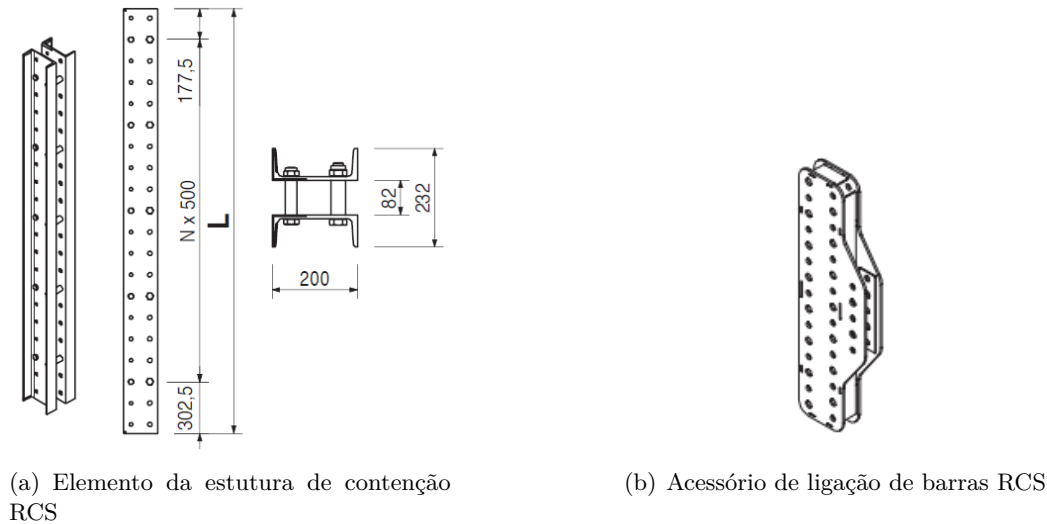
Elemento da estrutura de contenção de fachada: RCS. Retirado de [33]
